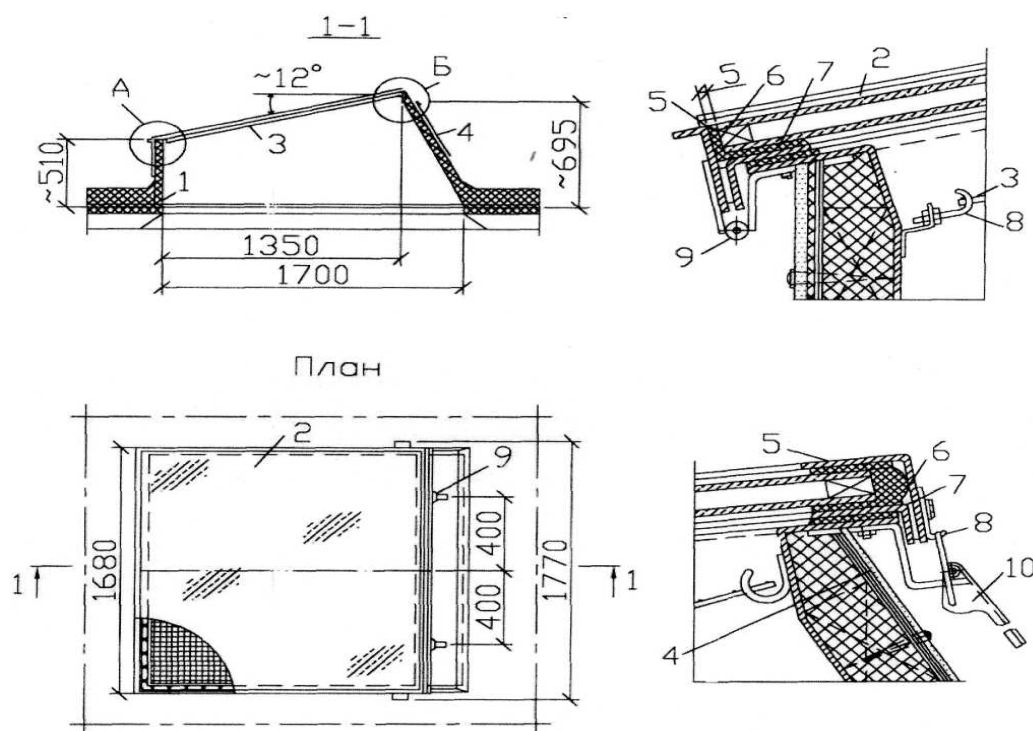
Точечный открывающийся зенитный фонарь со светопропускающим заполнением двухслойного стеклопакета: 1 – опорный стакан; 2 – стеклопакет; 3 – защитная сетка; 4 – фартук; 5 – уплотнитель; 6 – гнутый уголок; 7 – прокладка; 8 – крюк; 9 – петля; 10 – зажим
